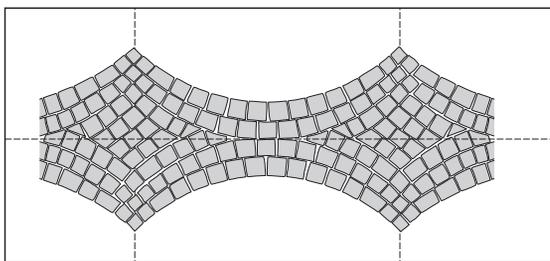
Changement d'orientation d'un appareillage mosaïque au point haut du profil longitudinal de la chaussée (as de carreau)
